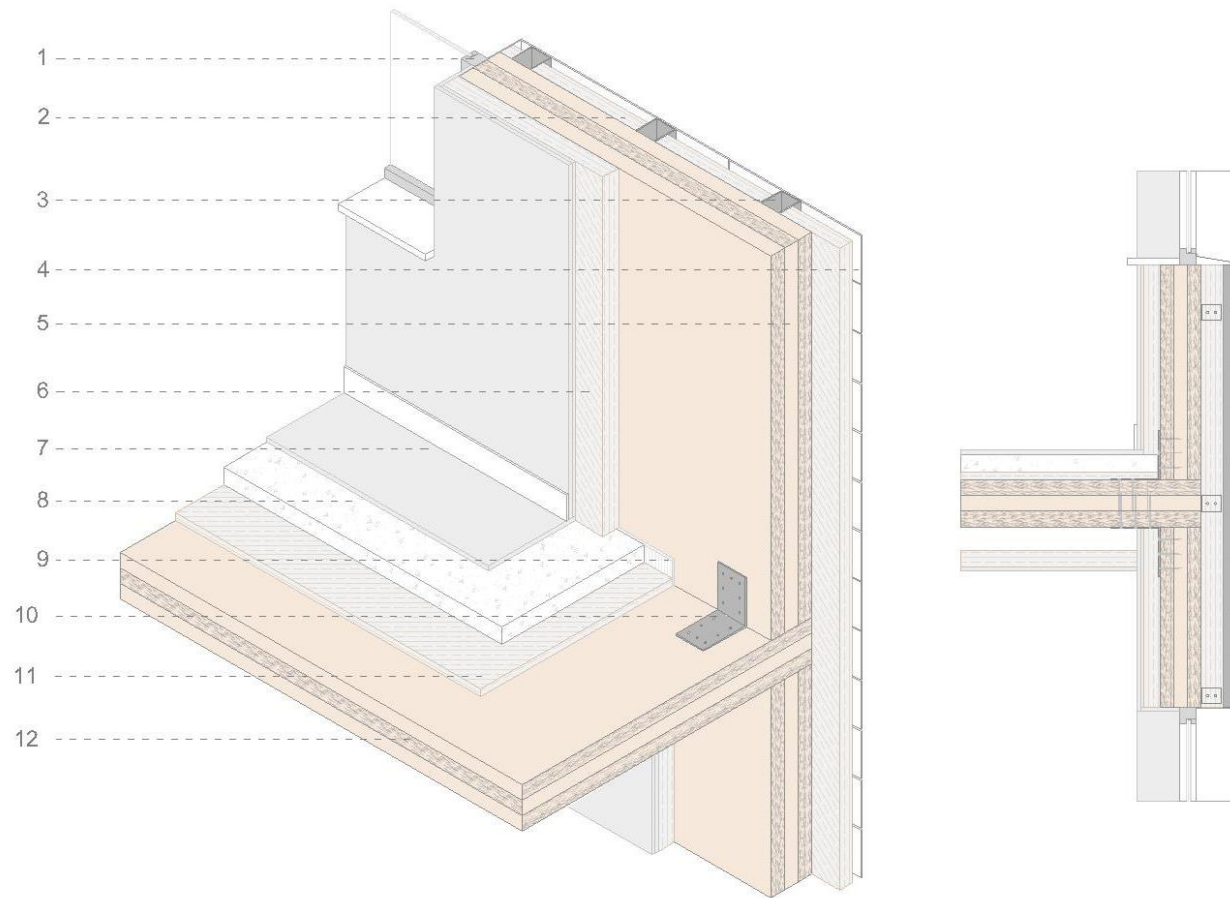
Detalle constructivo tipo de las uniones con herraje metálico edificio y clavos de Stadthaus
